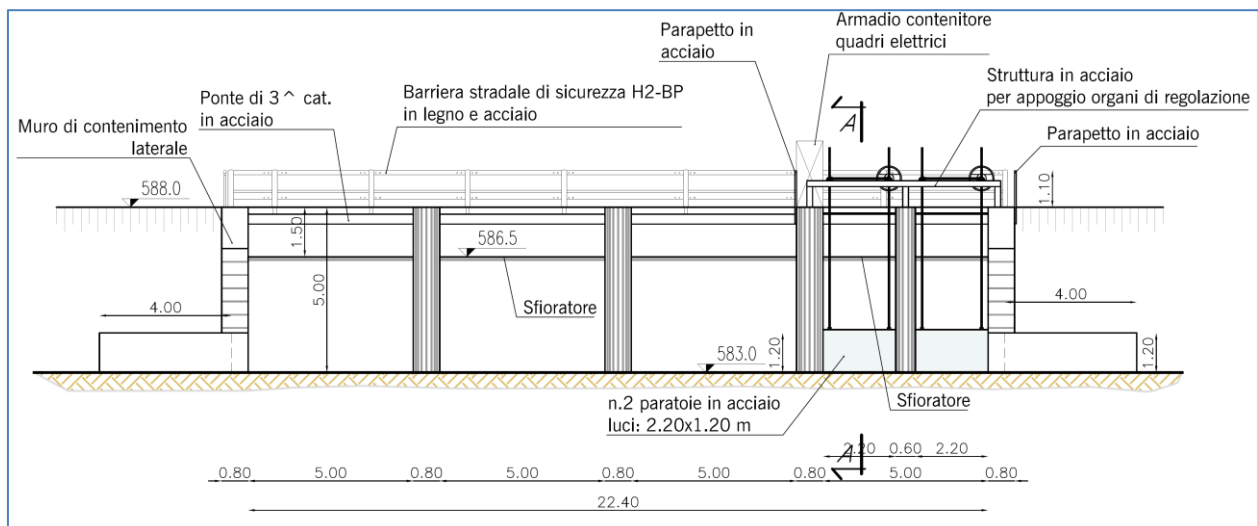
Cassa sul T. Turano. Prospetto lato cassa del manufatto di restituzione.
